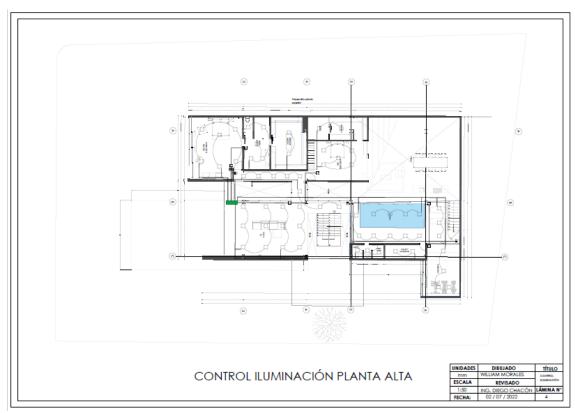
Plano del diseño de control de iluminación con Loxone planta alta.
